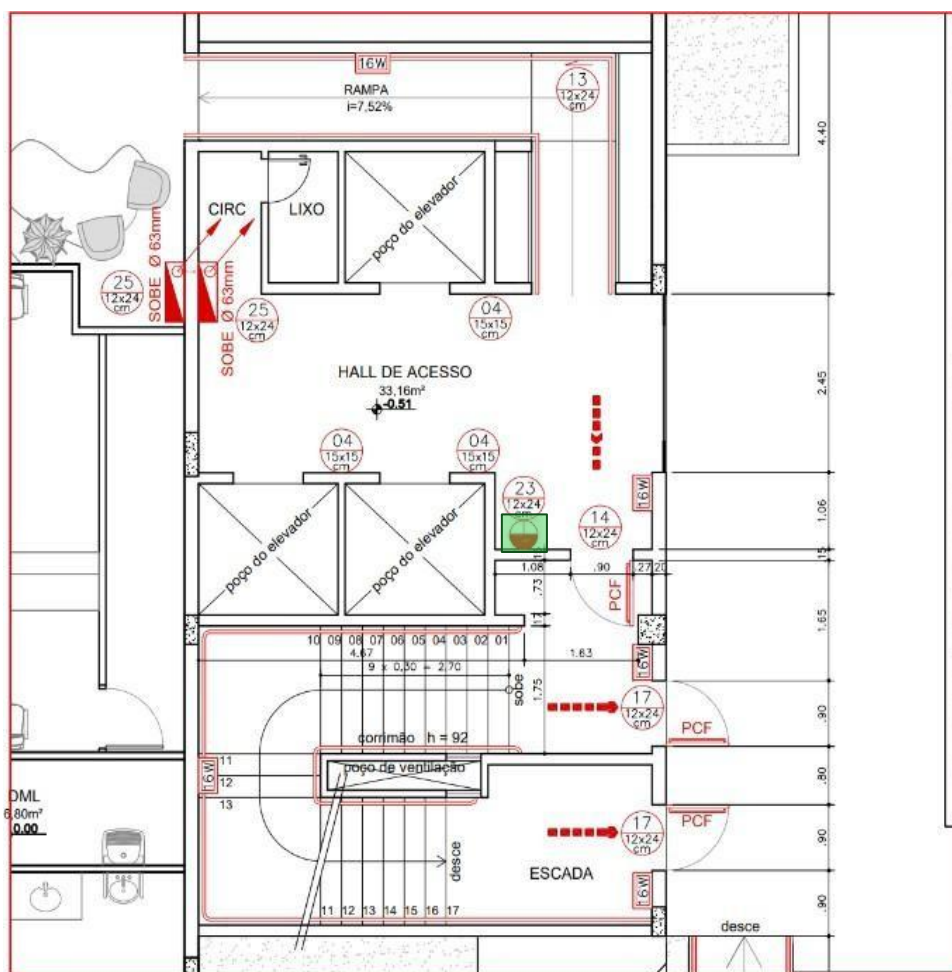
Planta baixa do layout proposto, destacando a localização dos extintores de incêndio.
